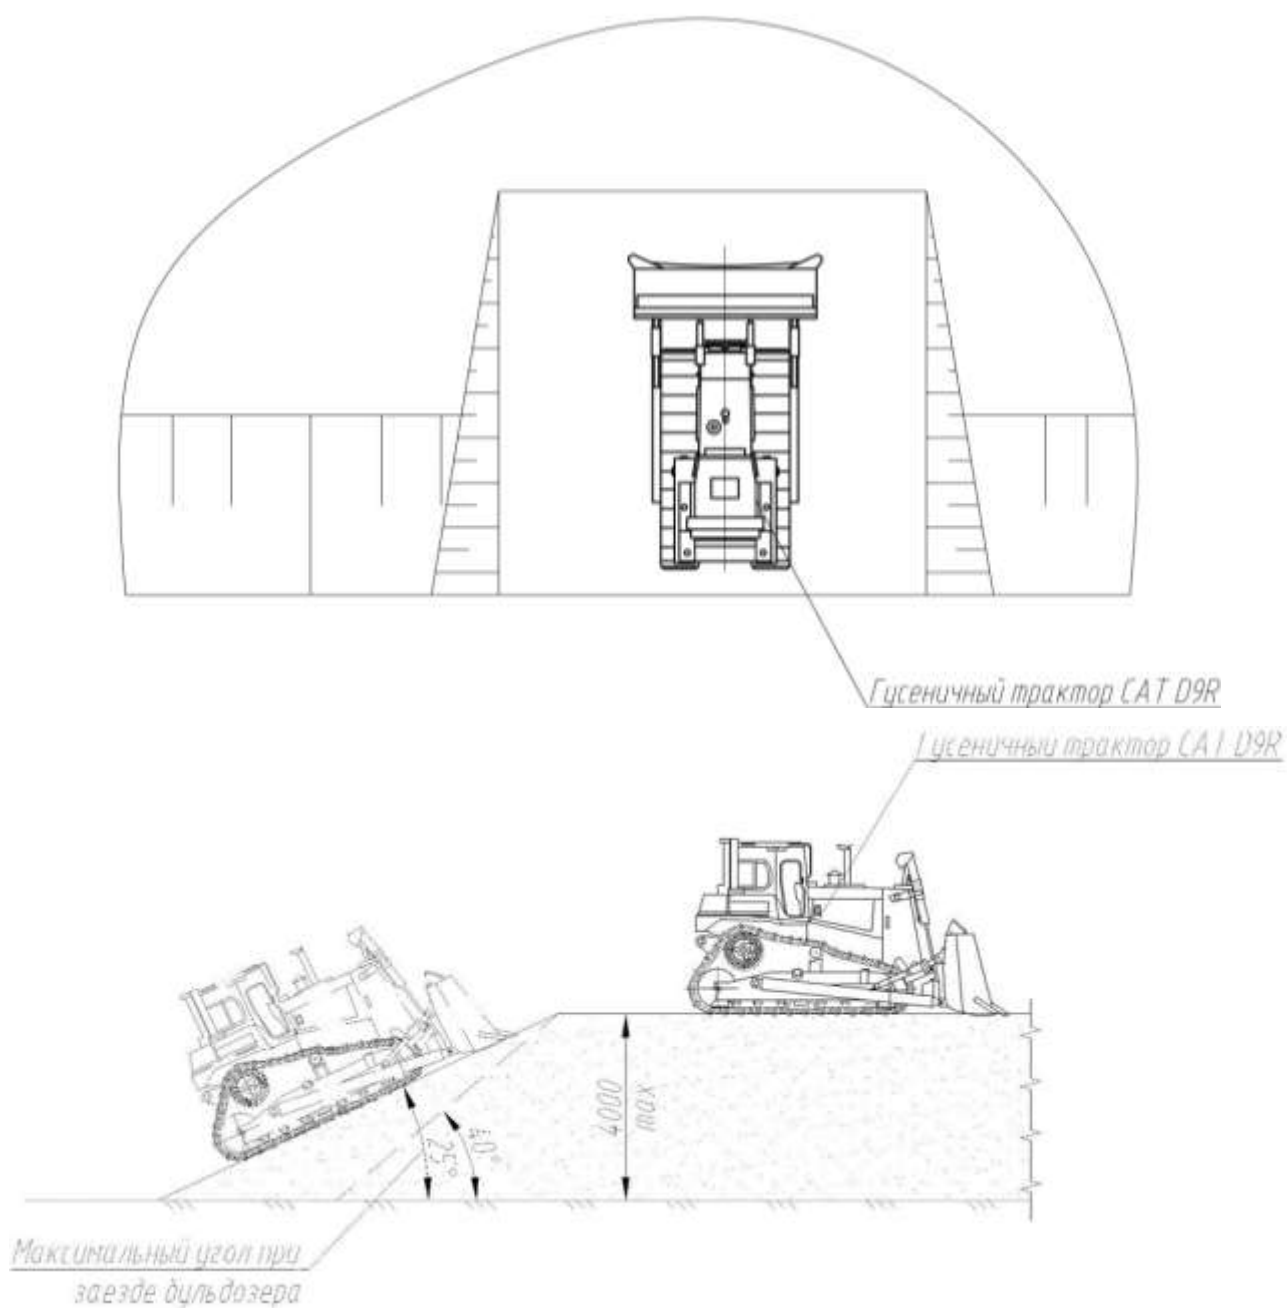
Схема формирования штабеля угля бульдозером
